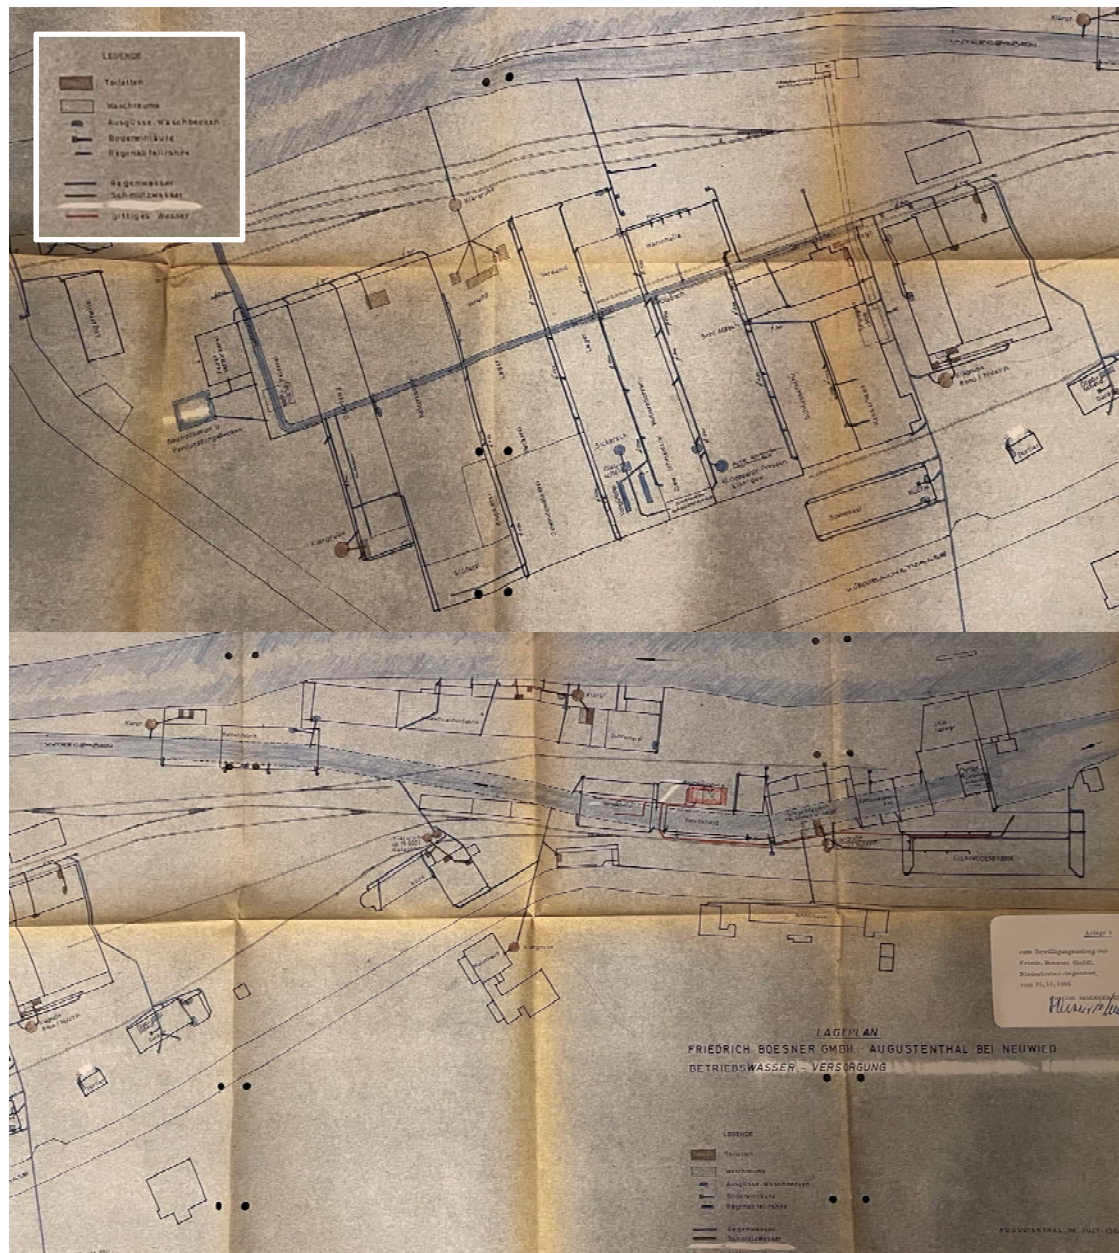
Lageplan 2-geteilt, Betriebswasserversorgung Boesner-Werk von 1966 [26].
